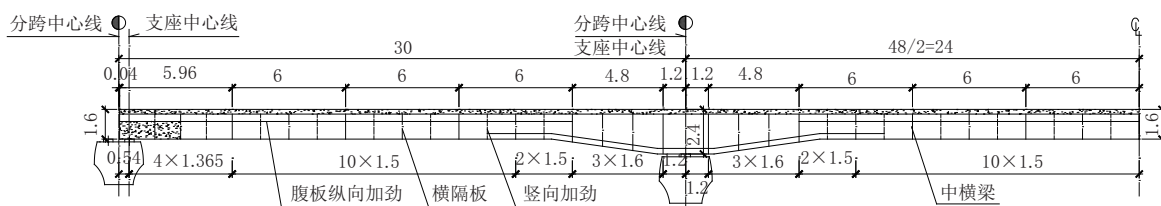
30 m+48 m+30 m 三跨变梁高连续钢箱组合梁立面布置图(单位:m)
